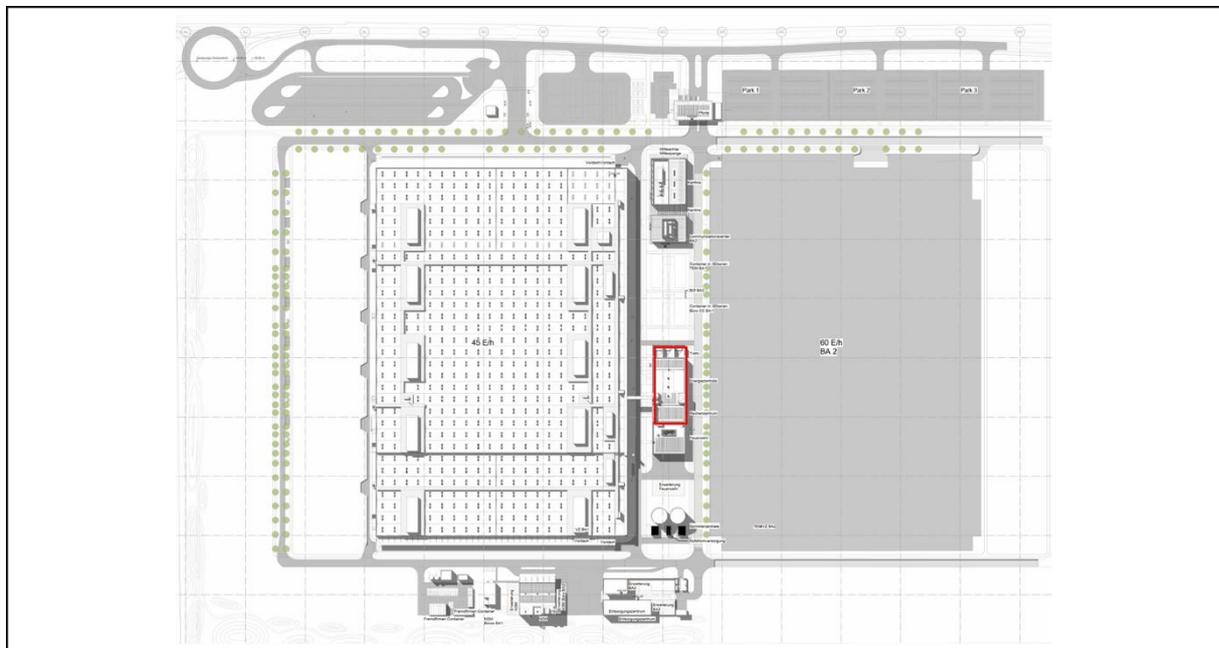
Energiezentrale Lageplan Dachaufsicht
